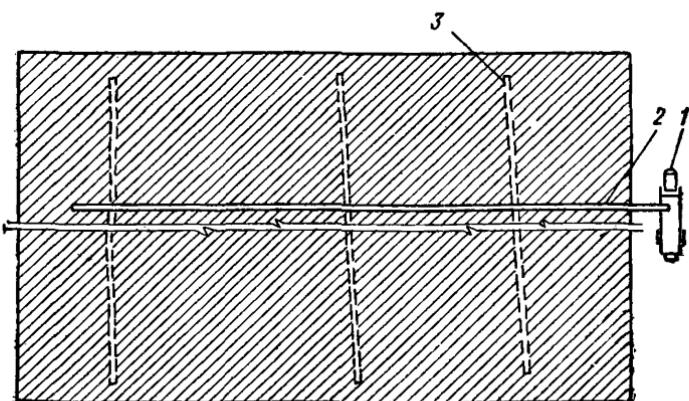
Схема бетонирования массивных конструкций стационарным бетононасосом
